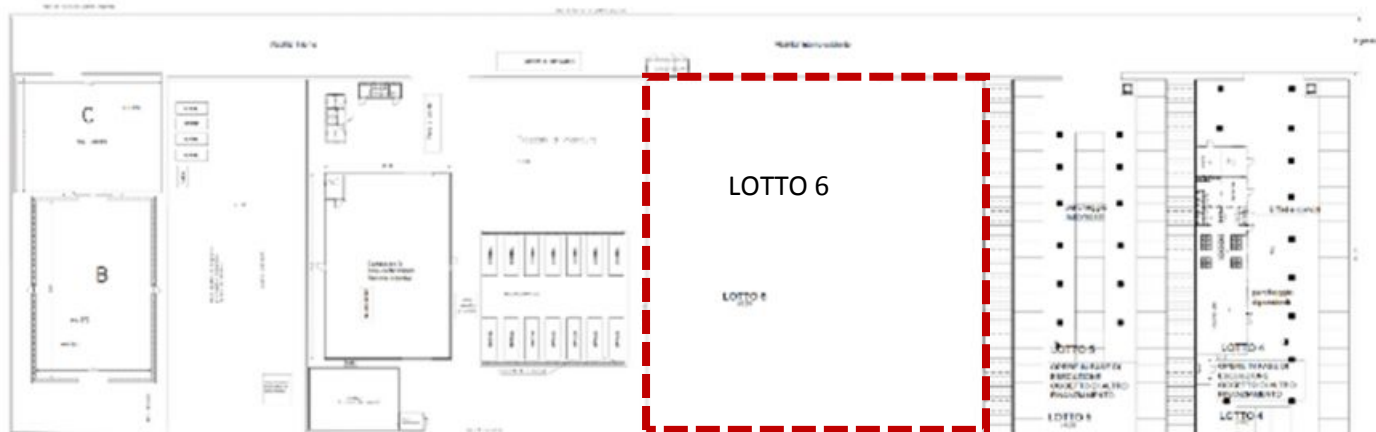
Planimetria generale Assetto attuale – Individuazione del lotto 6
